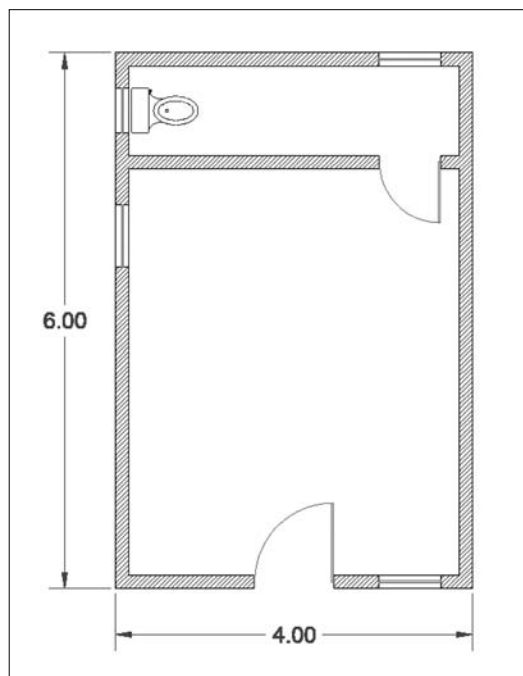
Planta tipo del pie de casa del Programa FONDEF.
